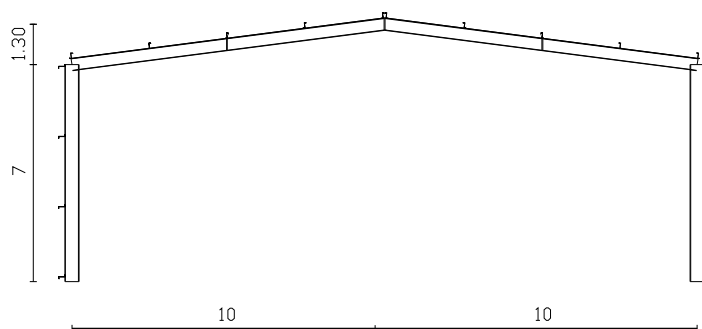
Pórtico rígido viga e pilar de alma cheia, vão de 20.00m
